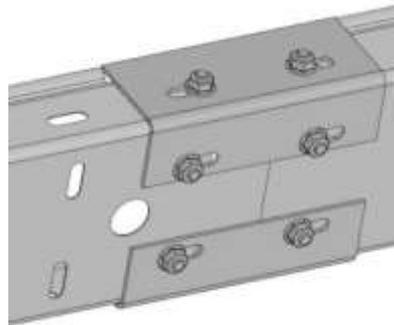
Соединение перфорированного лотка с помощью соединителя лотка бокового с дополнительным нижним креплением.
